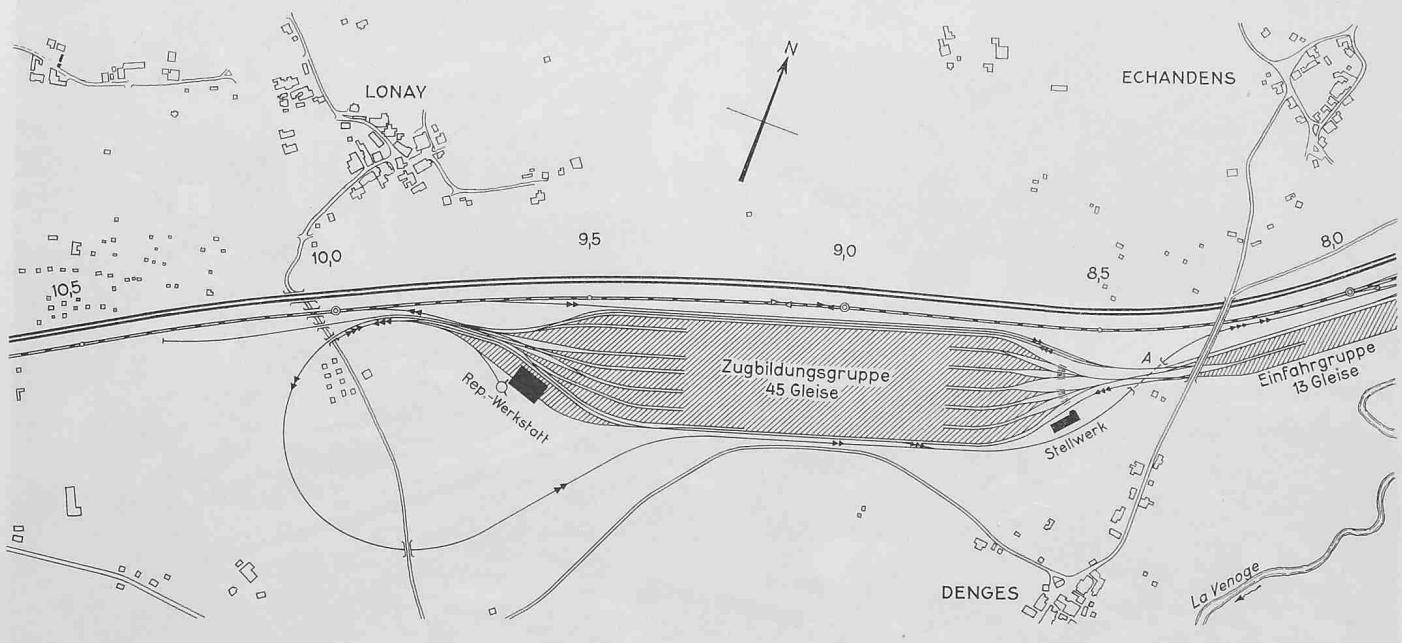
Rangierbahnhof Lausanne-triage der Schweiz. Bundesbahnen, Lageplan 1:15 000 (linke Hälfte)
